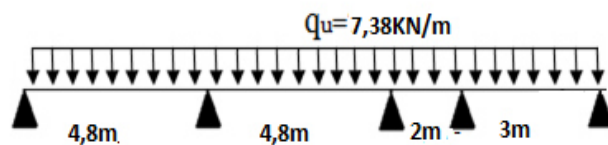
Schéma statique d'une poutrelle type 1 à l'ELS.
